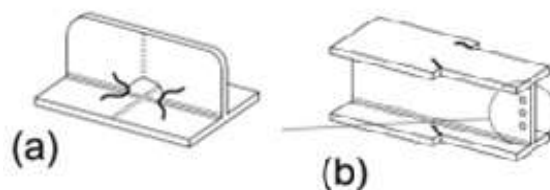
Detalle de ejemplos de secciones fisuradas por fatiga a) fisuras por fatiga b) fisuras por fatiga en las alas.
